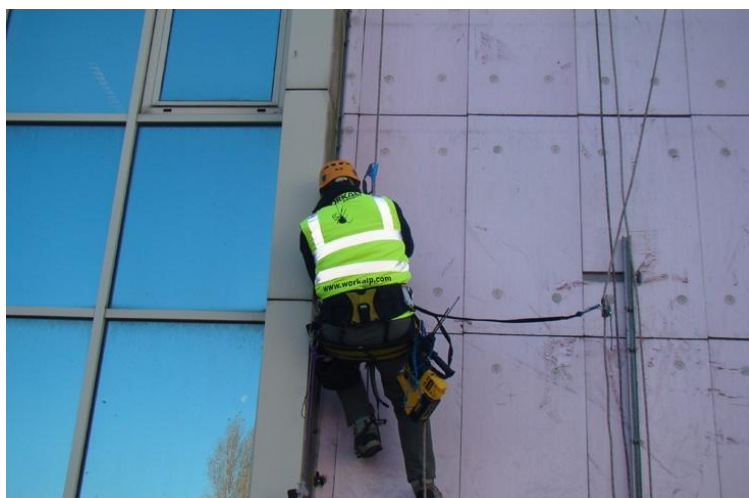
Montagem em obra de um sistema de fachada ventilada (Fonte: <http://workalp.pt/>)
